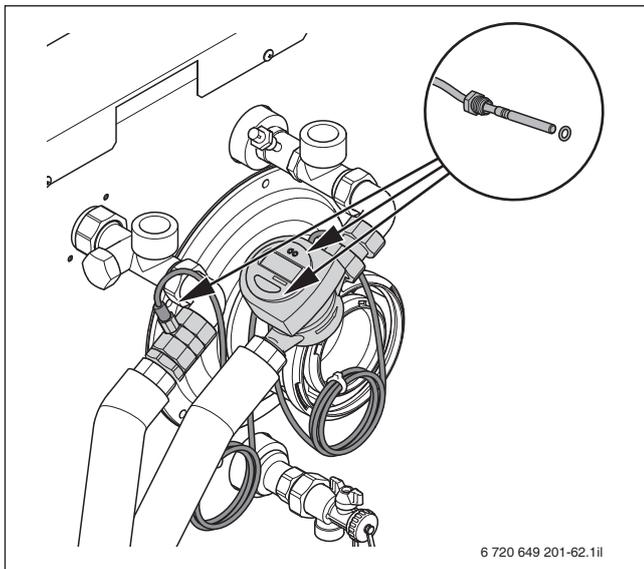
Einbauposition Anschluss-Set Wärmemengenzähler
